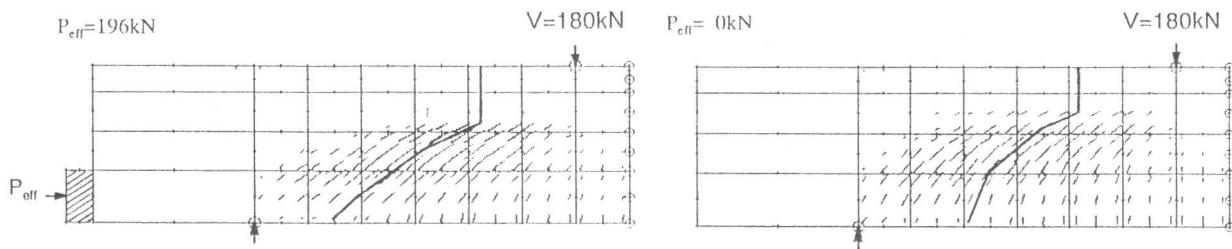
ひび割れ性状と抵抗断面(供試体PP-P)
